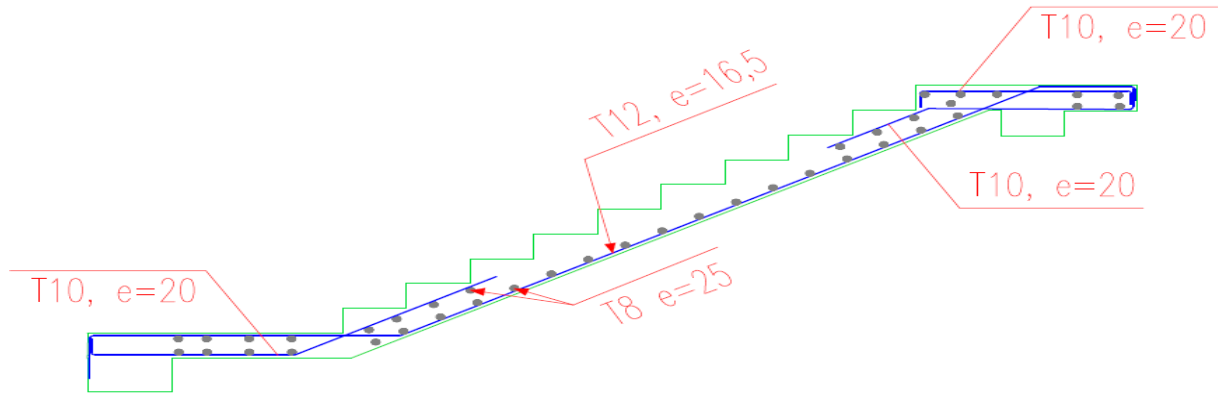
Schéma de ferrailage d'escalier étage courant.
